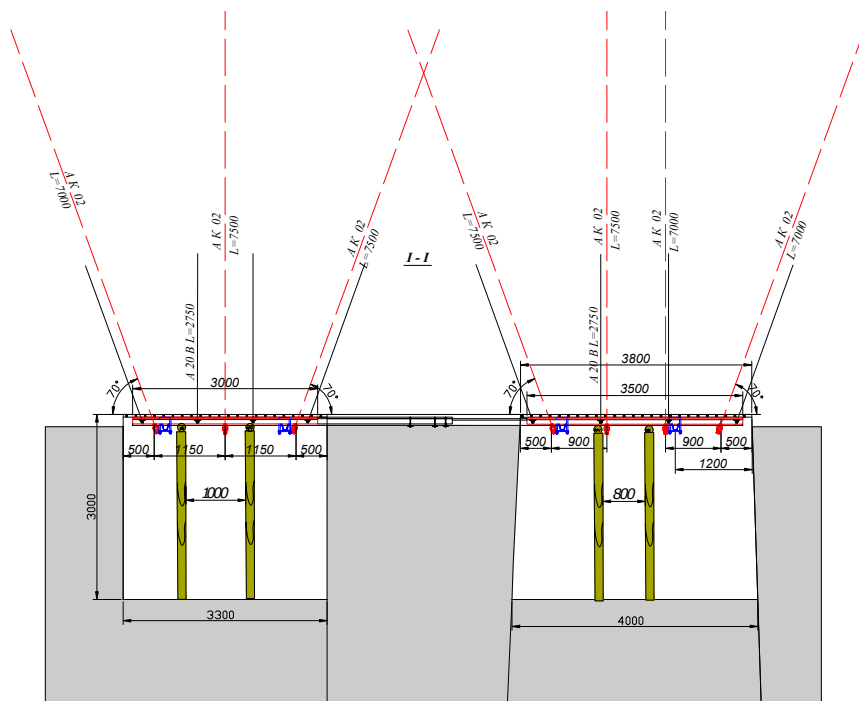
Схема крепления ППДК с двумя демонтажными выработками
